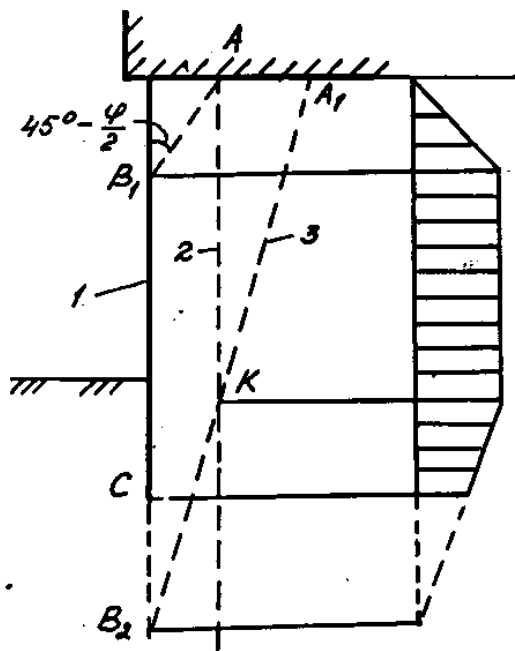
Схема к определению бокового давления грунта на переднюю шпунтовую стенку при наличии вертикальных свай между шпунтовой стенкой и наклонным экранирующим свайным рядом:
